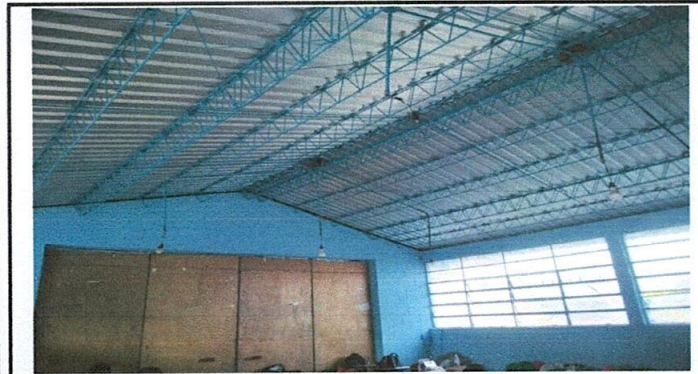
Sistema electrico en malas condiciones quebrados en einexistentes
